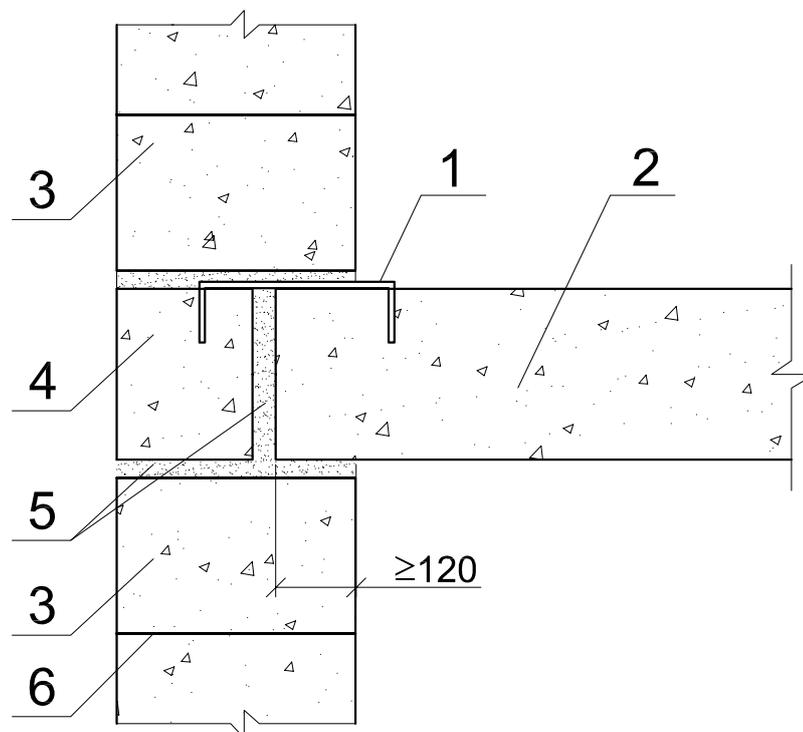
Опираие газобетонных плит перекрытия ГРАС на наружную несущую стену из блоков ГРАС по ряду кирпичей
